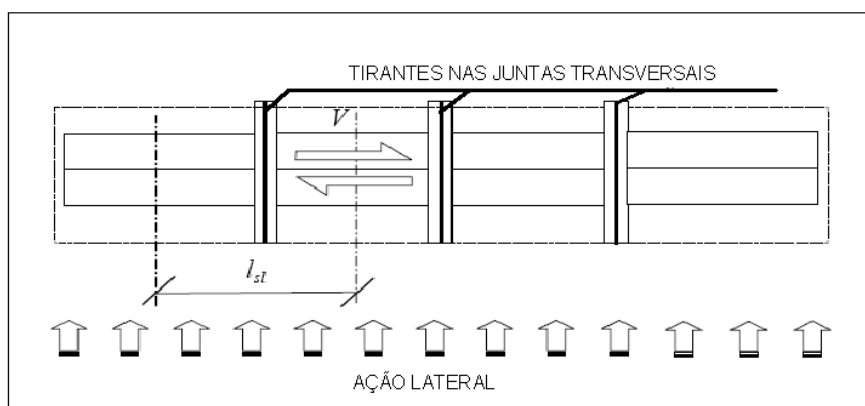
3 – Disposição padrão das armaduras de reforço: laje perpendicular a ação (BASEADO EM: FIB, 2006).
